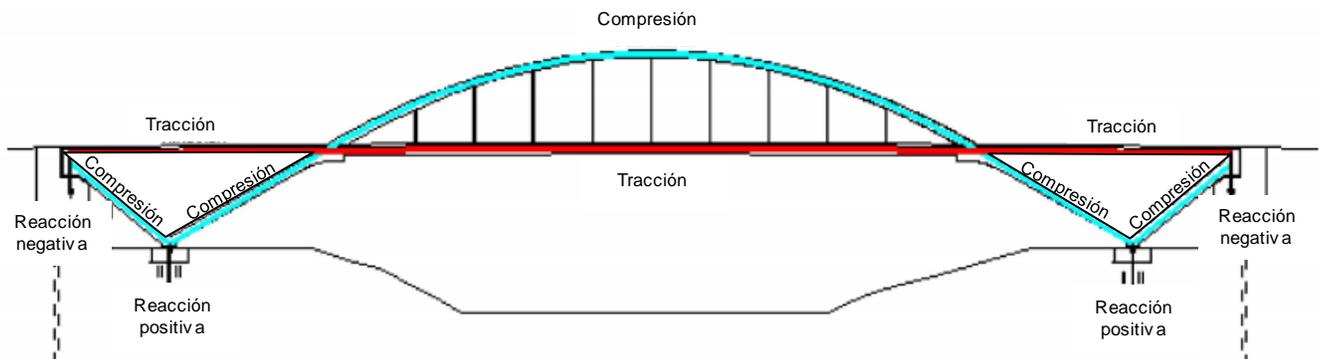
Esquema de tipos de esfuerzo en puente tipo arco atirantado
